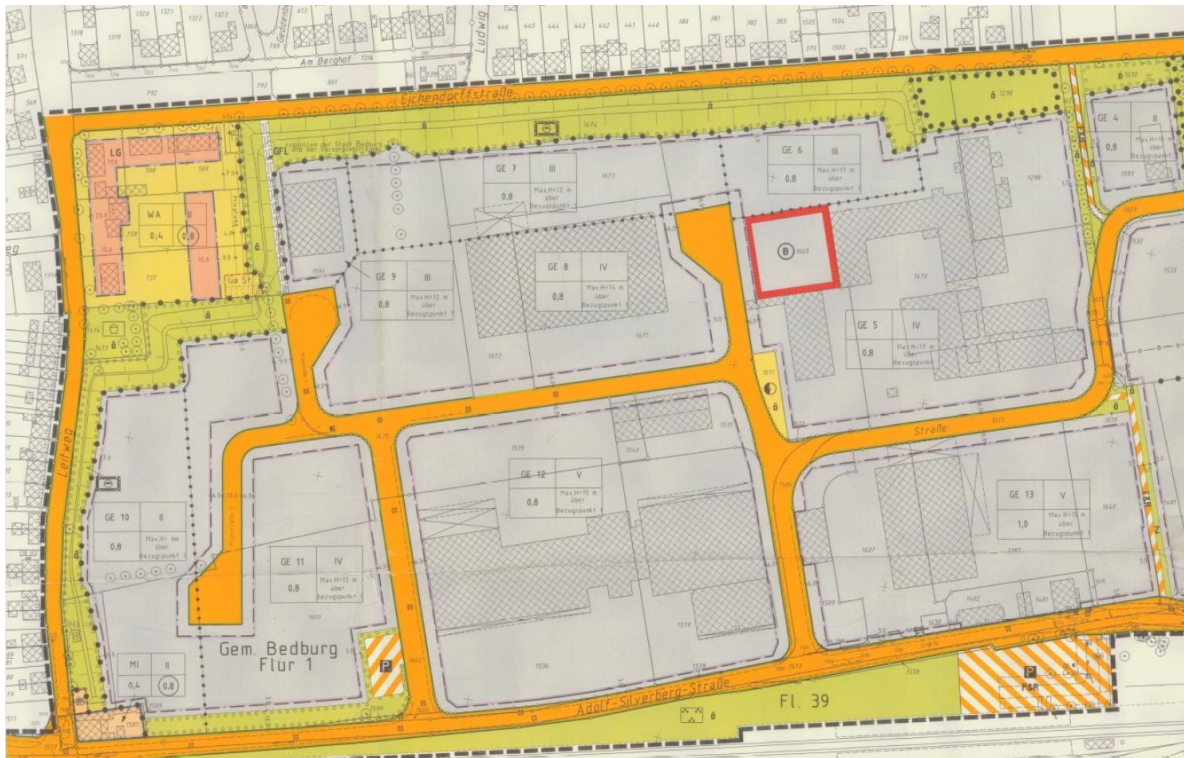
Derzeit rechtskräftige Planzeichnung des Bebauungsplan Nr. 43 der Stadt Bedburg (Ausschnitt: betroffenes Plangebiet; Datenlieferung: Stadt Bedburg).
